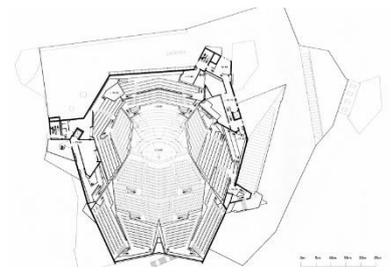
Configuración en planta de la Filarmónica de Berlín.
